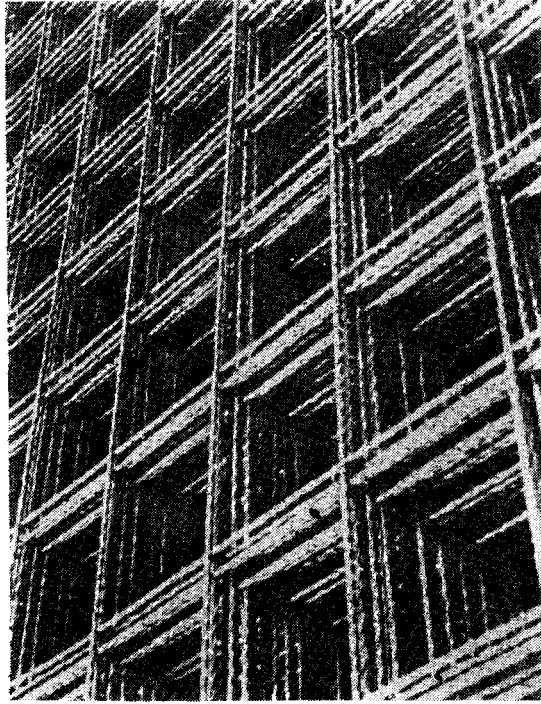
Арматура железобетона, сваренная точками
